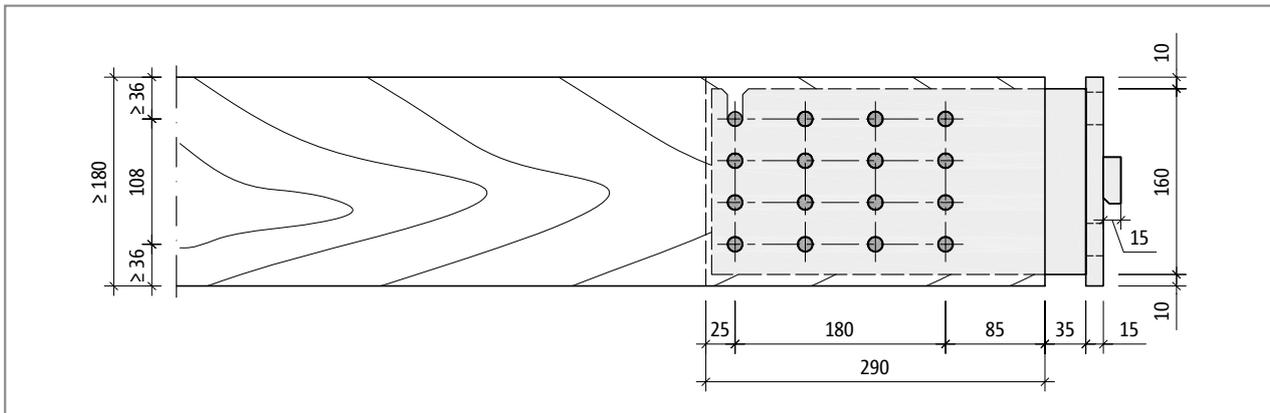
Schöck Isokorb® T Typ SK mit Stahlschwert: Stahlschwert mit angeschlossenem Holzbalken
